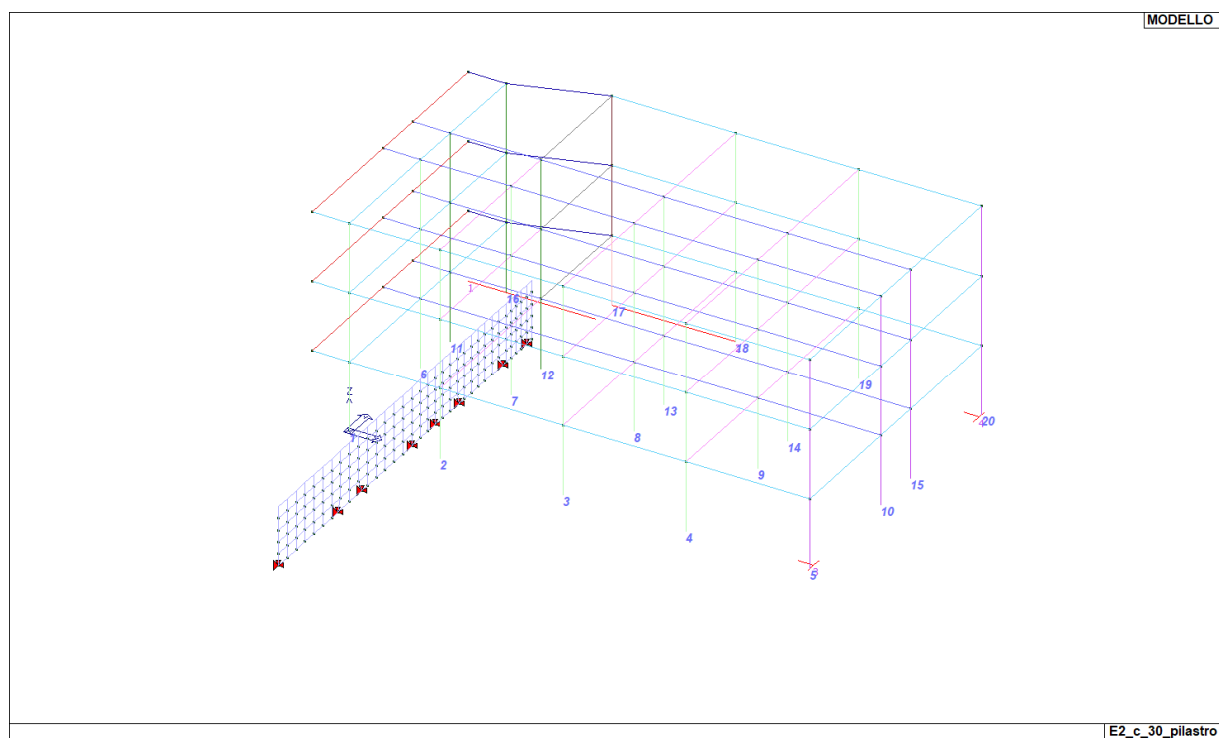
Vista assonometrica unifilare con numerazione pilastri
